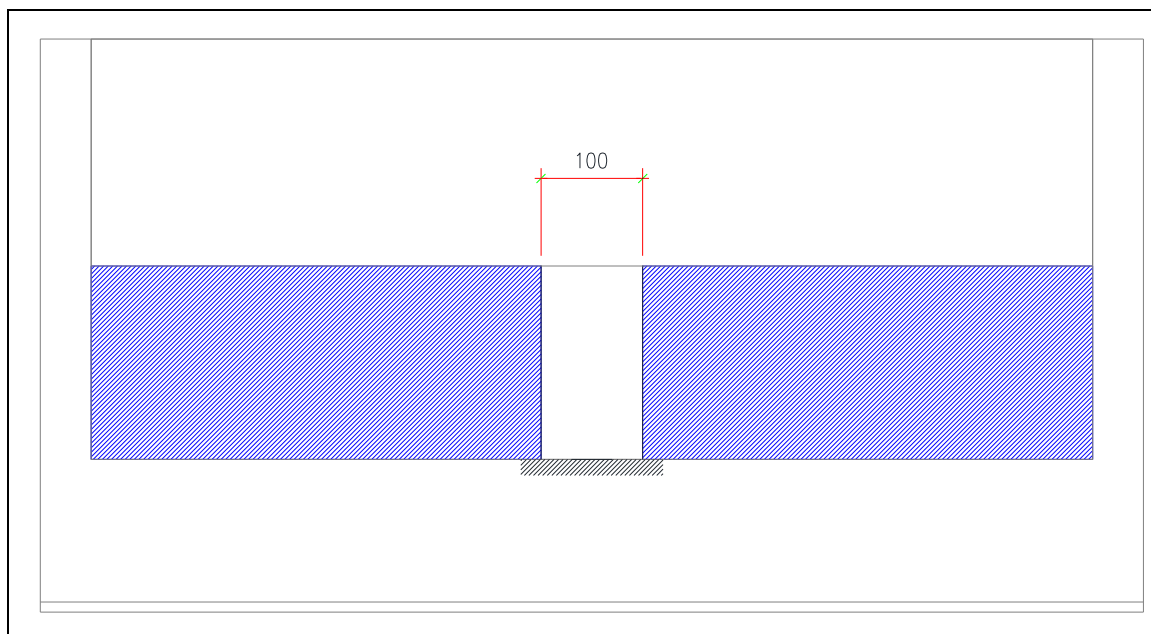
Spalla A - Schema statico equivalente assunto per muro in elevazione
